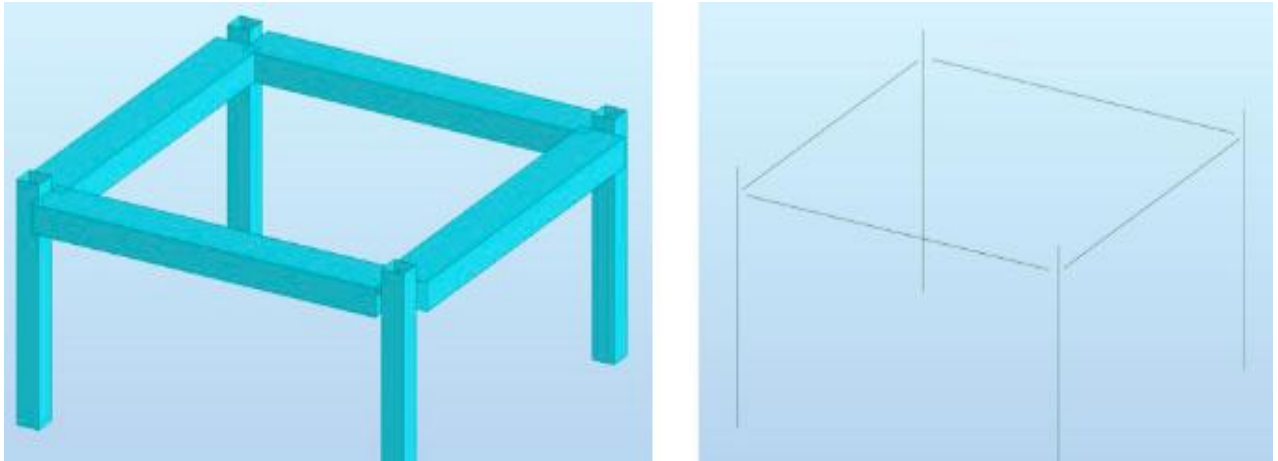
la liaison des composantes de la structure (poutres, poteaux) source auteurs
